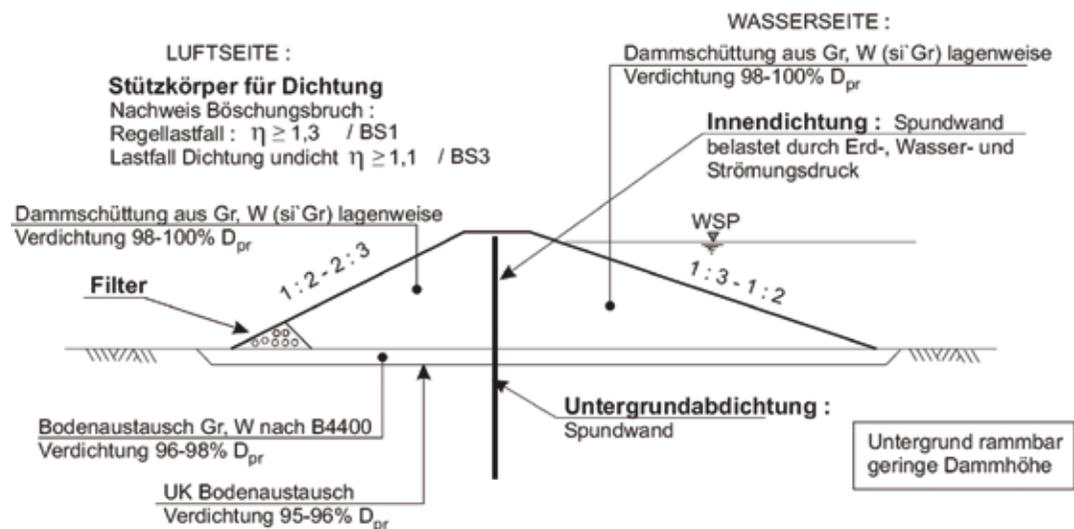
Bautyp – Damm und Untergrundabdichtung mit Spundwand
